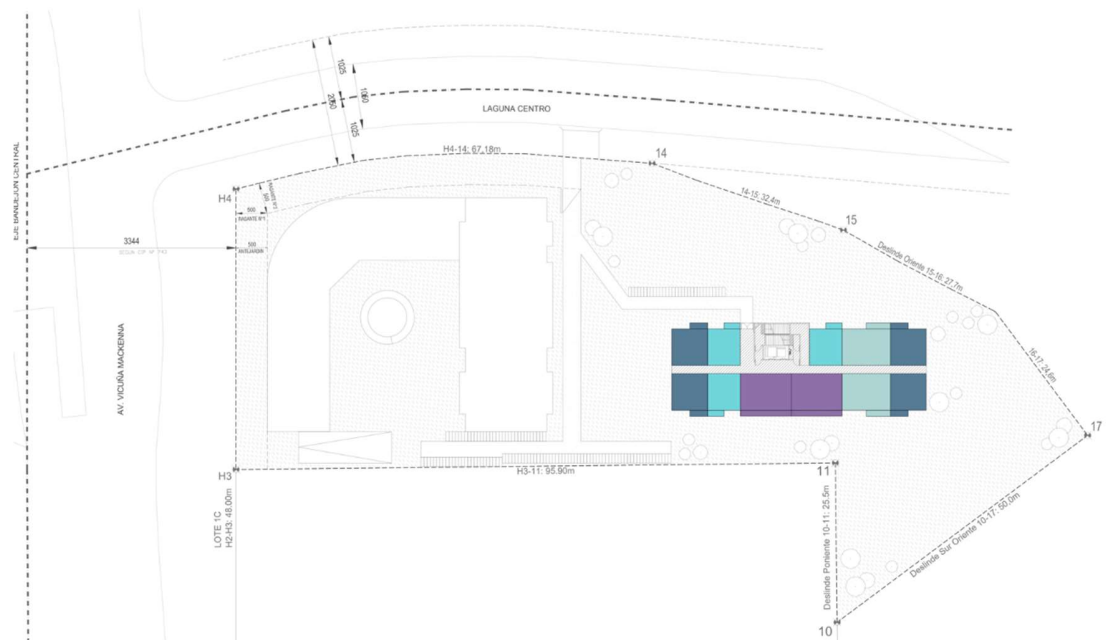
Planta 18 al 25 piso. Fuente: Elaboración propia
